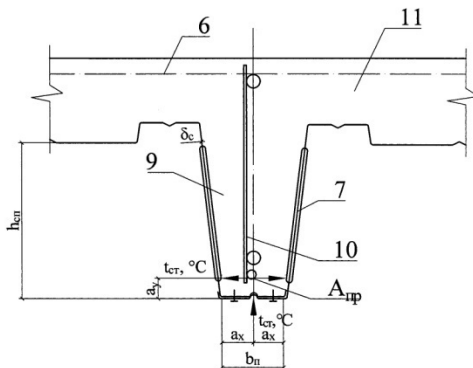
Схема основного поперечного сечения перекрытия к расчету огнестойкости монолитного сталежелезобетонного перекрытия [3], где: 6 - верхняя арматурная сетка; 7 - поперечные ребра жесткости; 9 - кессонообразователь; 10 - несущий каркас из стержневой арматуры; 11 - монолитный сталежелезобетонный строительный элемент; a_x и a_y - глубина заделки стержня арматуры, мм; $t_{ст}$ - толщина листа стального профиля, мм.; $b_n = 2 \times a_x$ - ширина основания гофрированного профиля по оси x , мм; a_y - толщина защитного слоя по оси y , мм; $A_{кр}$, $A_{пр}$ - соответственно площадь сечения конструктивной и проектной арматуры в пролете перекрытия, кв. мм.
